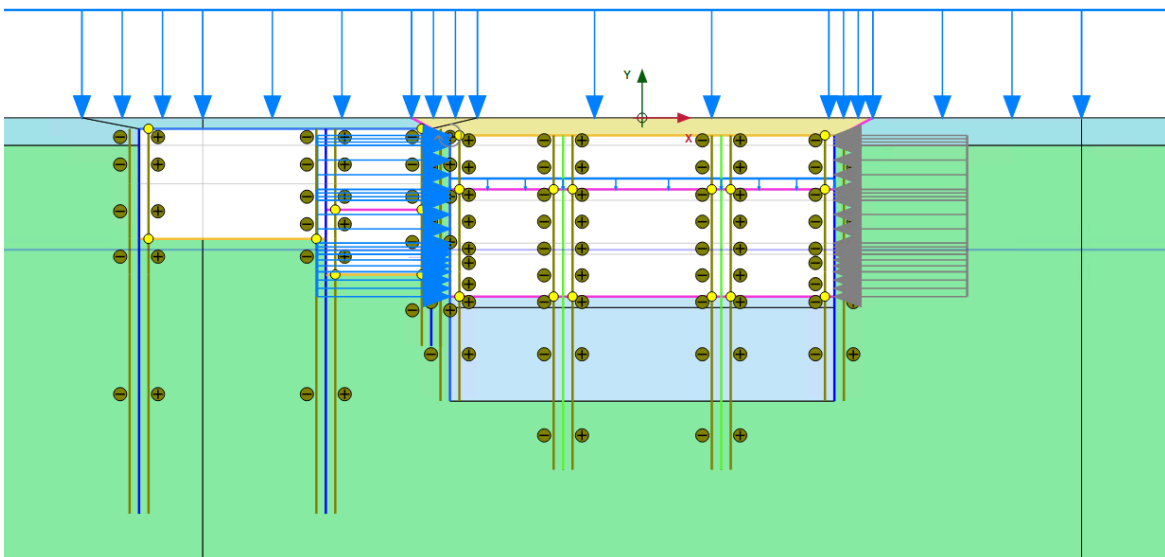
Fasi di calcolo modello geotecnico sezione AA
